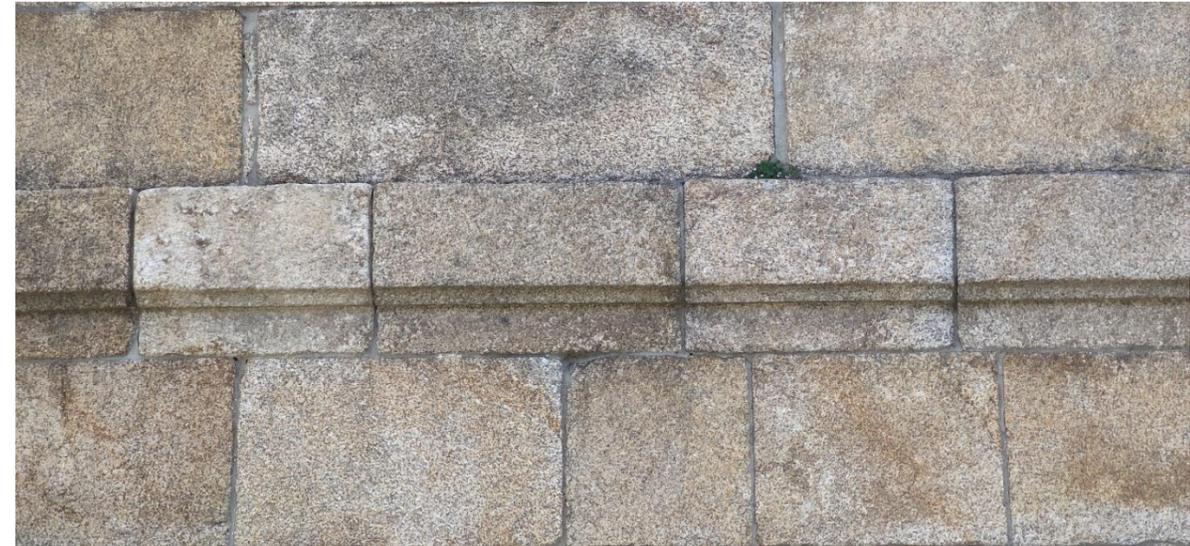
detalle de morteiros de cemento na fachada da Rúa Veeduría
